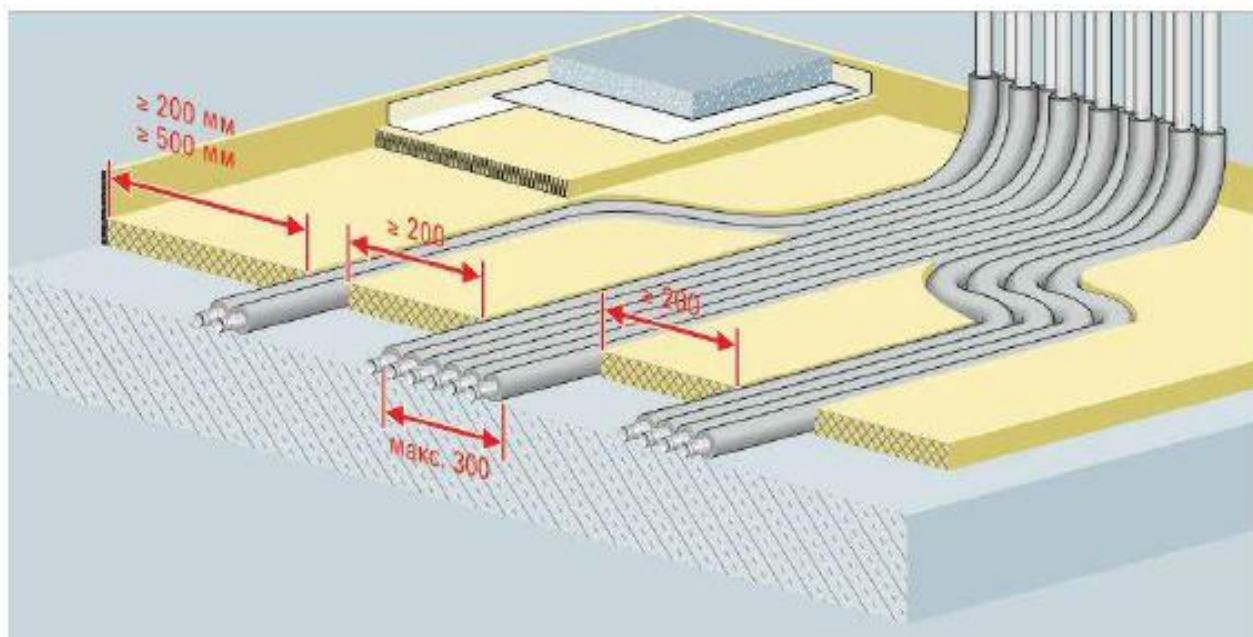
Ширина траси трубопроводів і ширина опорних поверхонь.
